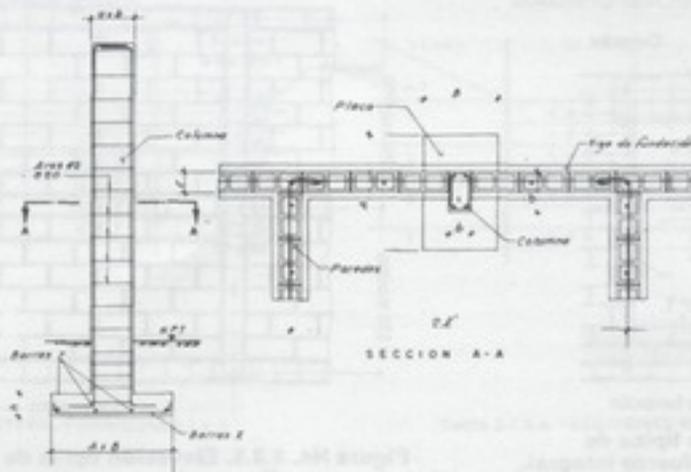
Detalle de columna de concreto reforzado para rigidizar paredes.
